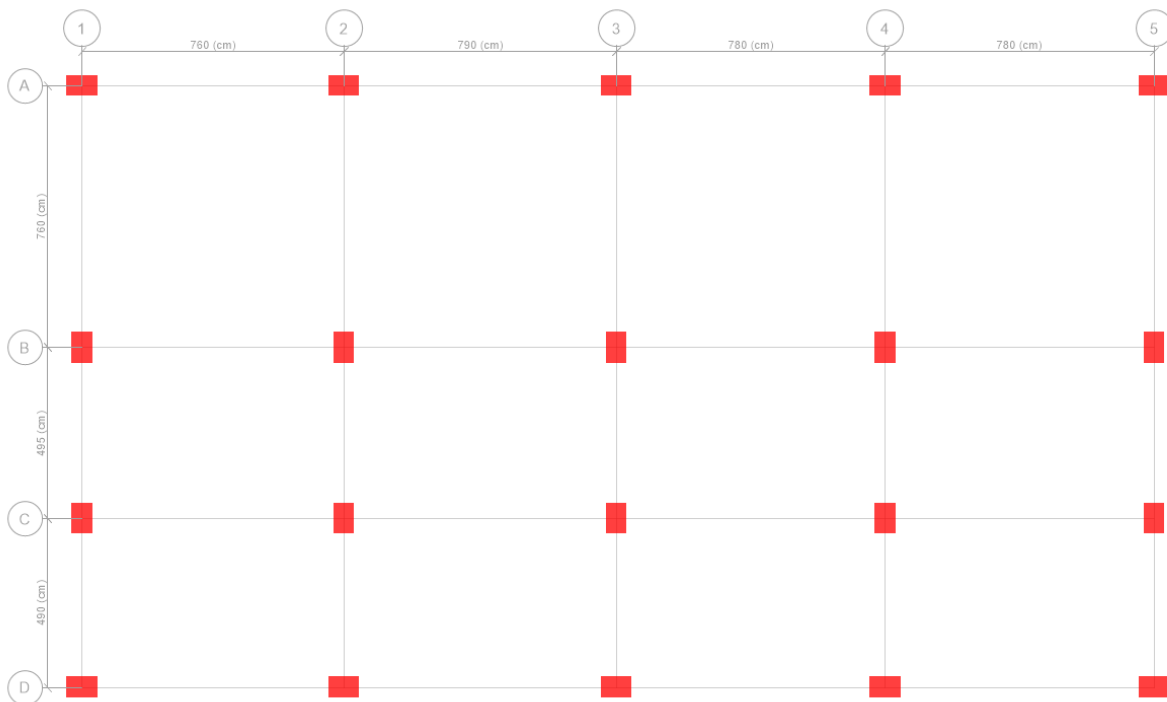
Vista en planta de columnas para el caso de estudio 2 – Etabs
